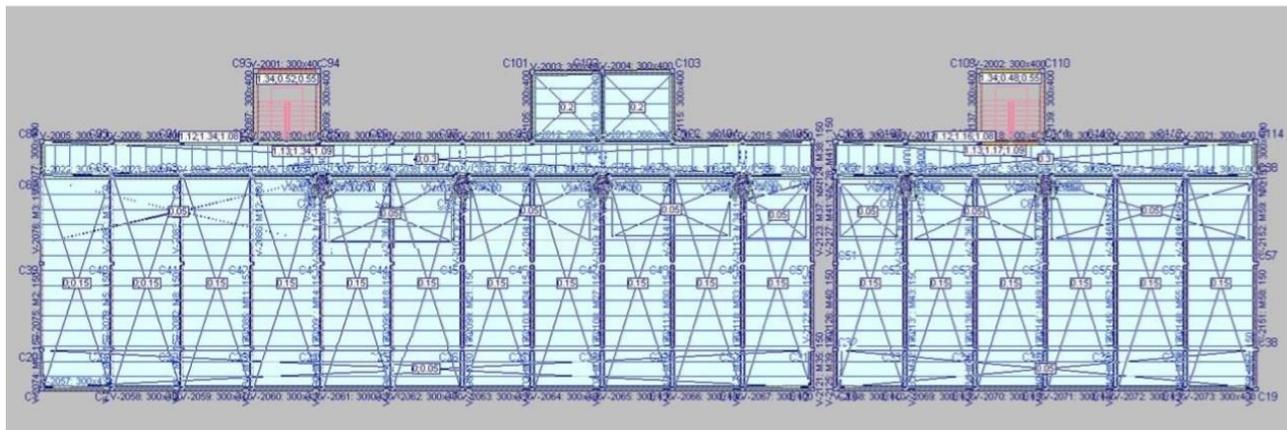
Planta general del bloque habitacional. Fuente: Datos de arquitectura, EPROB.
